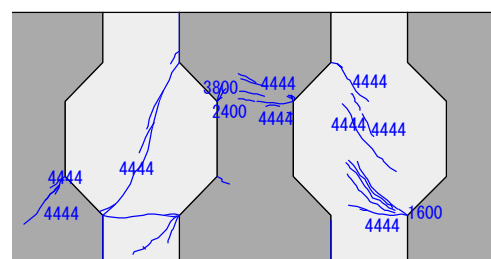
ひび割れ図（せん断キー有り：No.3）
